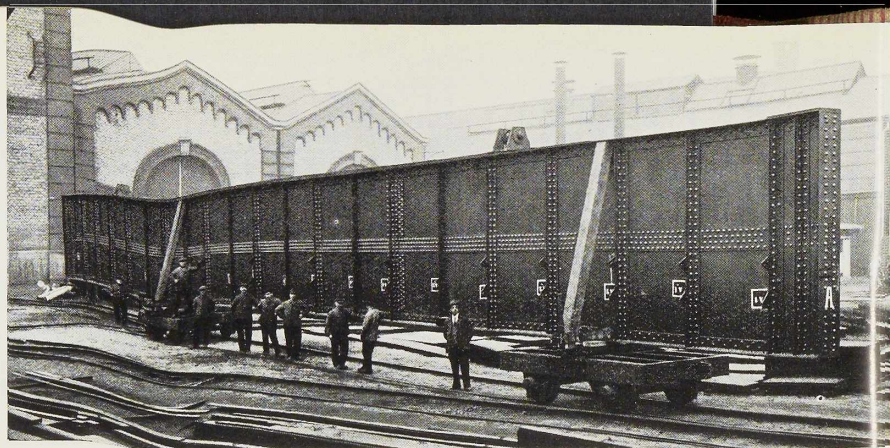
Poutre à âme pleine à raidisseurs en diagonale du pont sur le canal de Charleroi à Hal.
